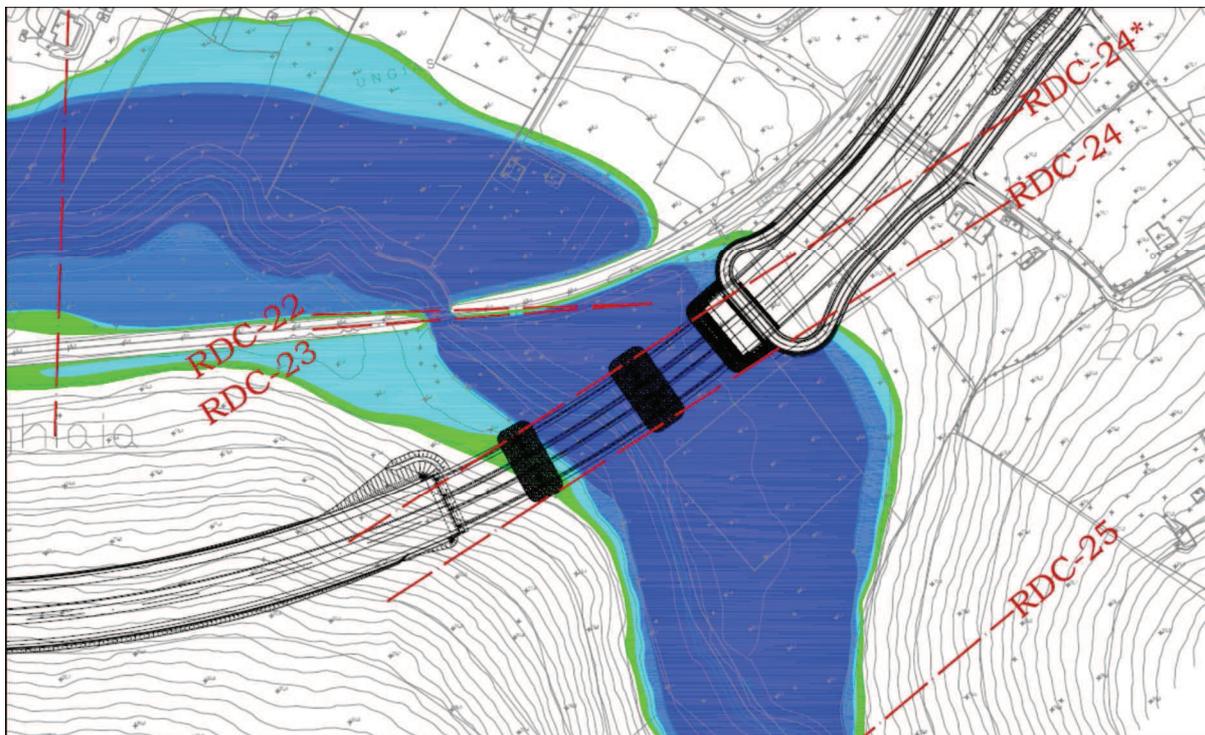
Viadotto Calvia 1. Planimetria delle aree di esondazione Post-operam
